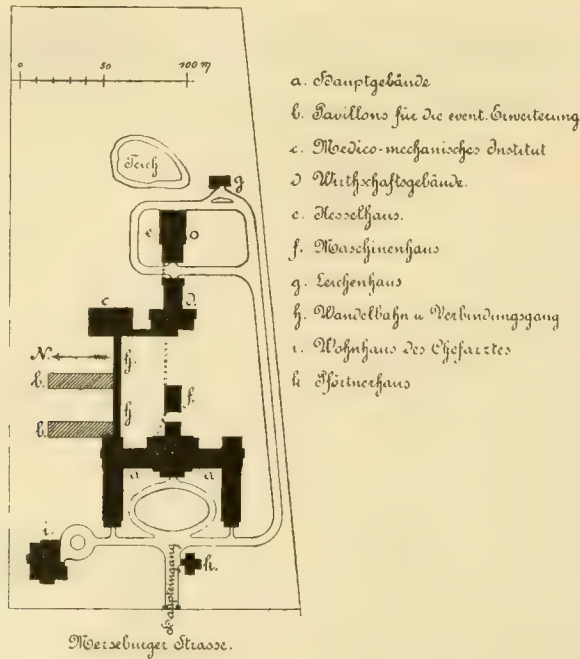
Krankenhaus „Bergmannstrost“ in Halle a. S. Lageplan.
